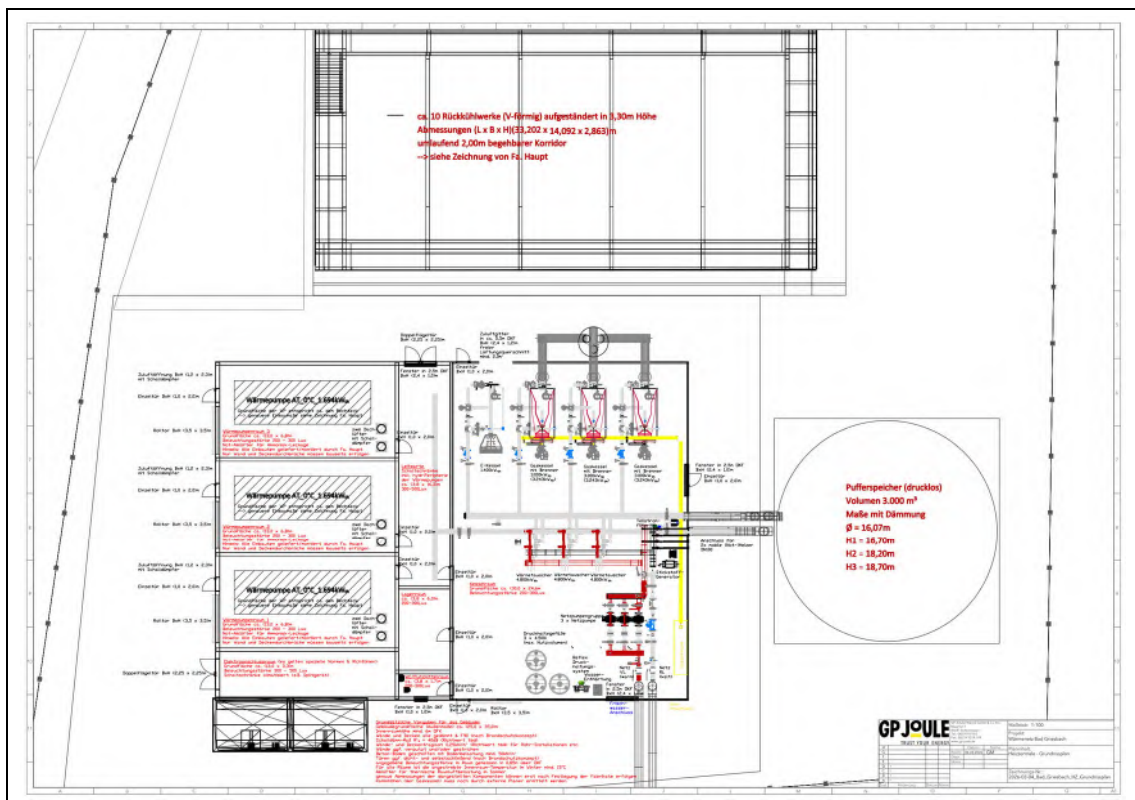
Grundriss der geplanten Anlage [25]
